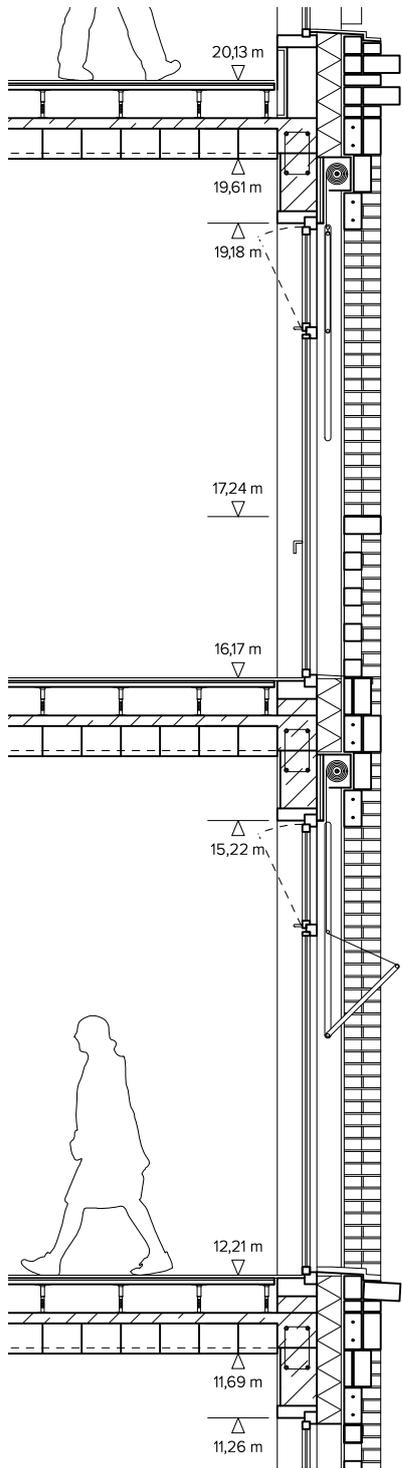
Fassadenschnitt 3. und 4. Obergeschoss 1.50 (BM)
